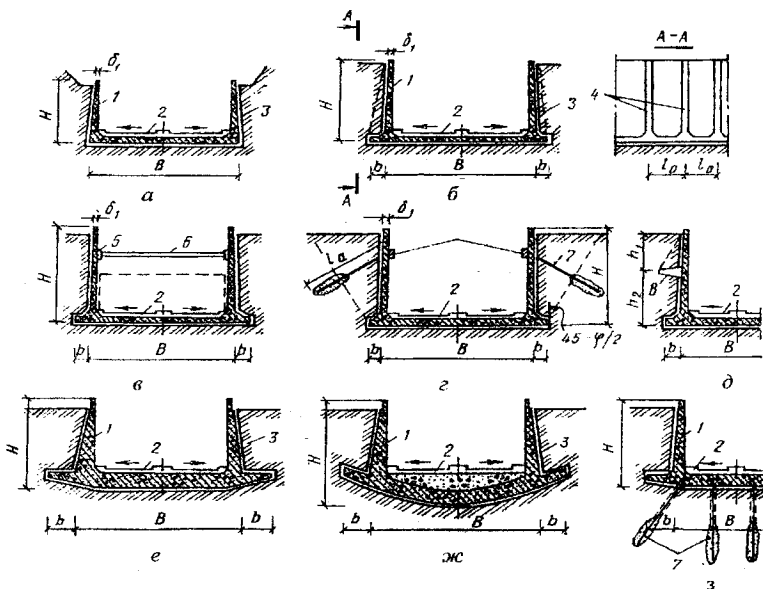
Конструкції рампи із монолітного залізобетону з консольними стінками (а, б, е, ж), з розпірками (в), з анкерами (г, з) і з консольними плитами, що розвантажують, (д):
